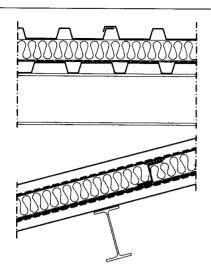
Zweischaliges wärmegedämmtes nichtbelüftetes Trapezprofildach (Pfettenkonstruktion)
